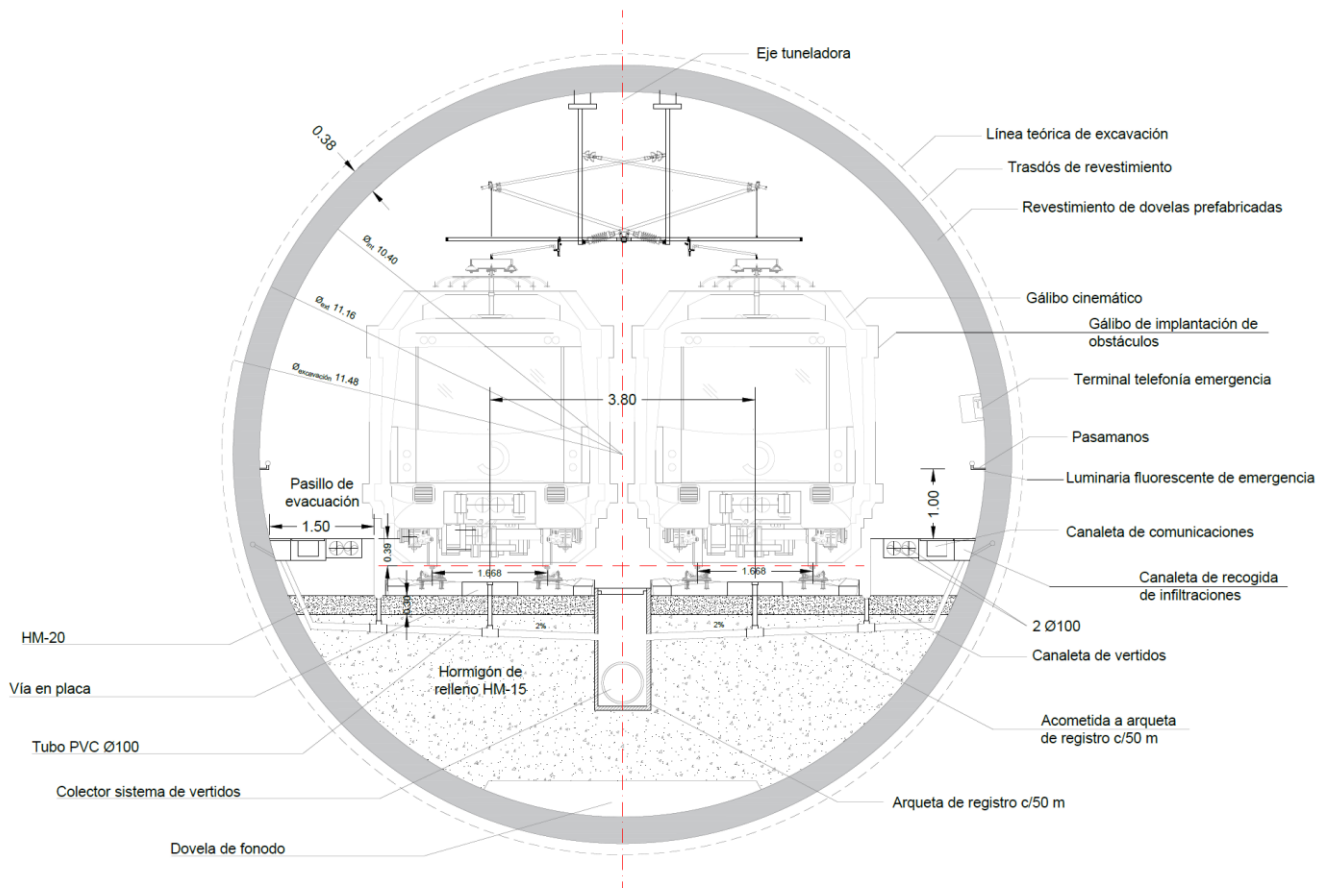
Sección tipo túnel con tuneladora. Elaboración propia
